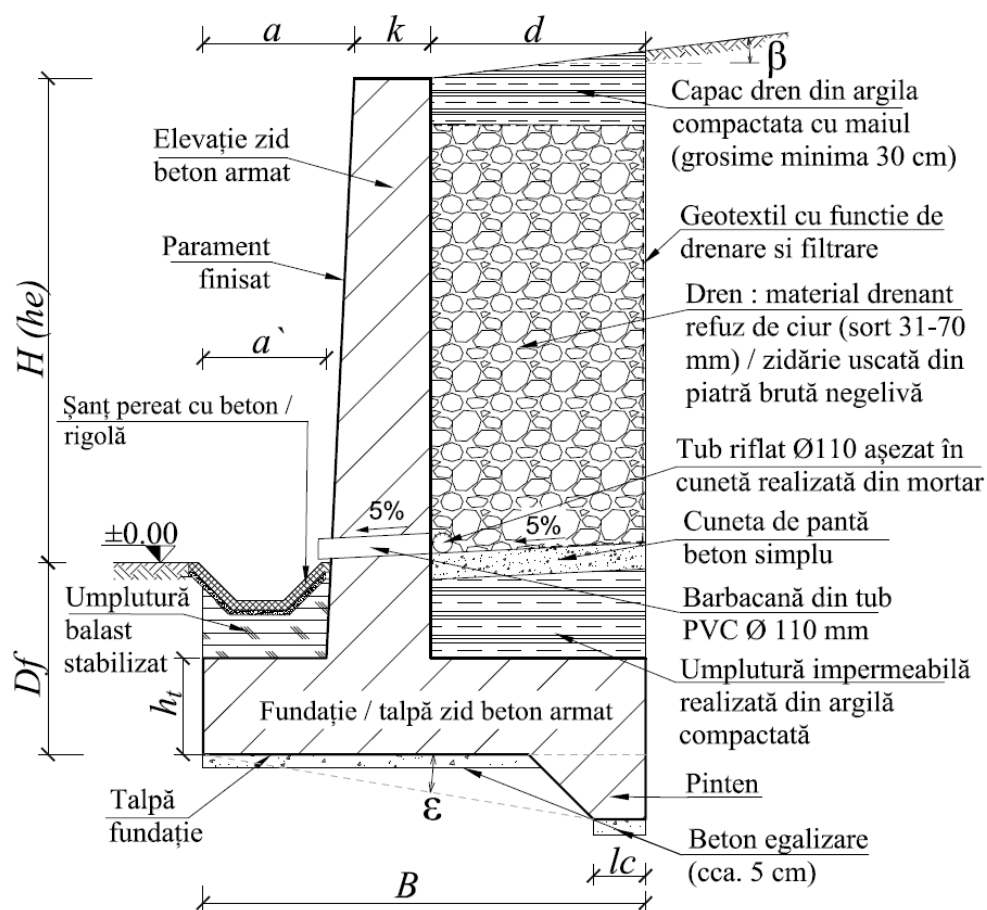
Secțiune transversală zid de sprijin din beton armat (1)
